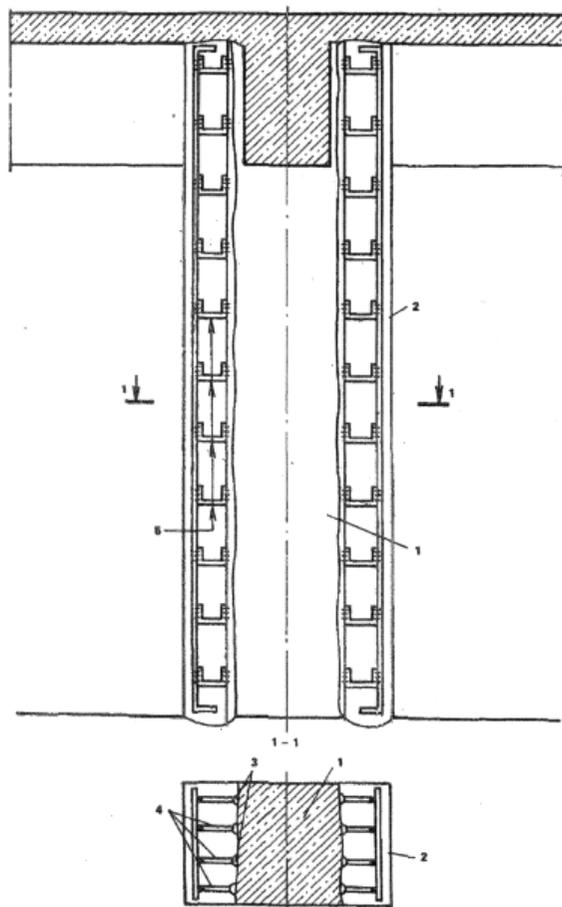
Конструкция усиления колонны двухсторонним наращиванием сечения:
